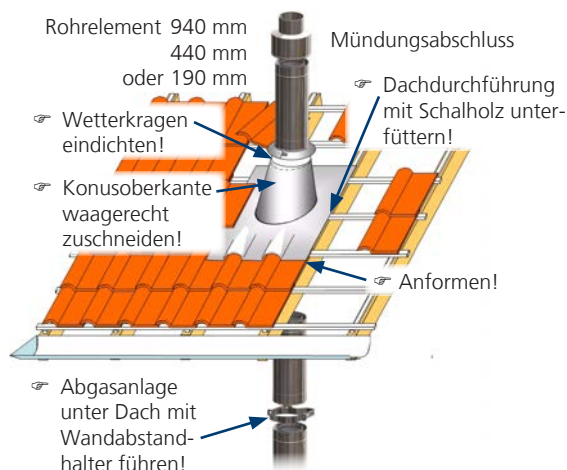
Schrägdach mit typischer Edelstahl-Dachdurchführung
